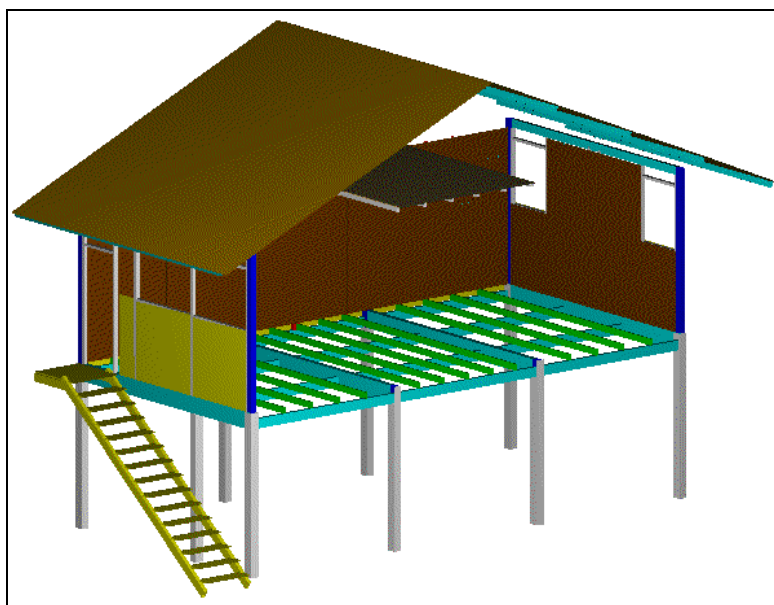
Modelagem preliminar da edificação, sem a parede frontal e tesouras de cobertura.
